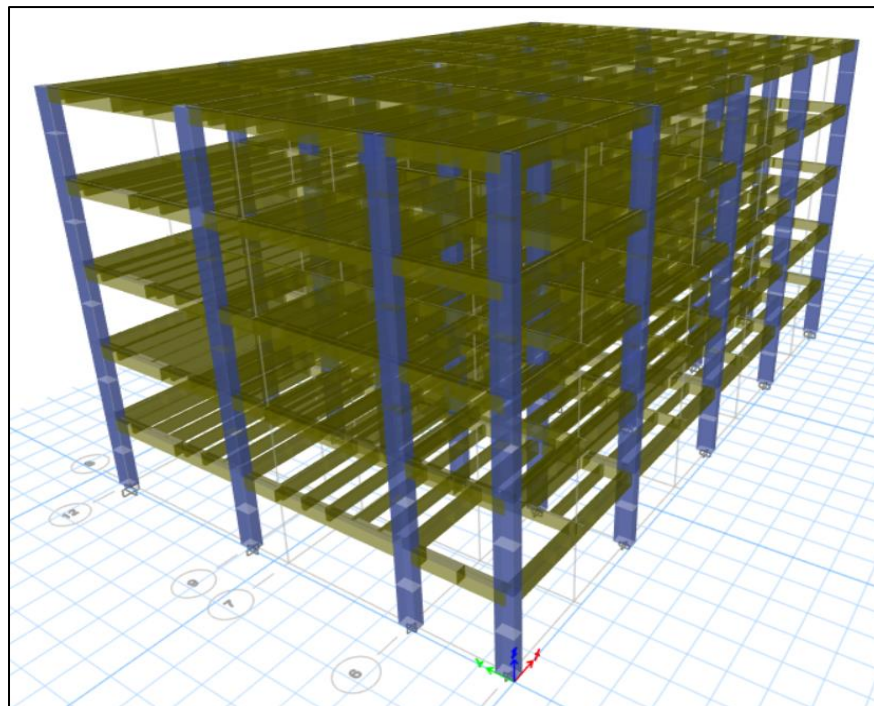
Vistas 3D - Edificación de 3 niveles con cubierta en placa
